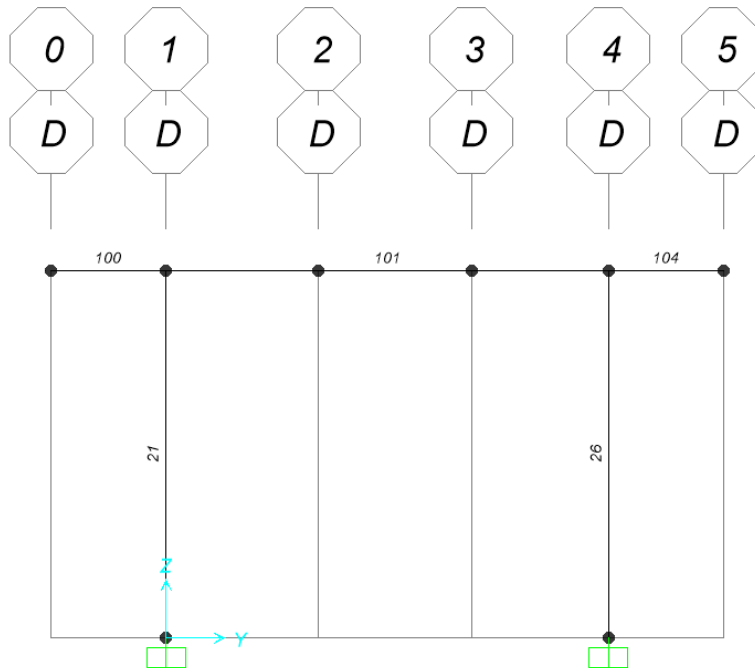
Vista in sezione modello struttura in elevazione –Filo B - numerazione elementi frame e joint
